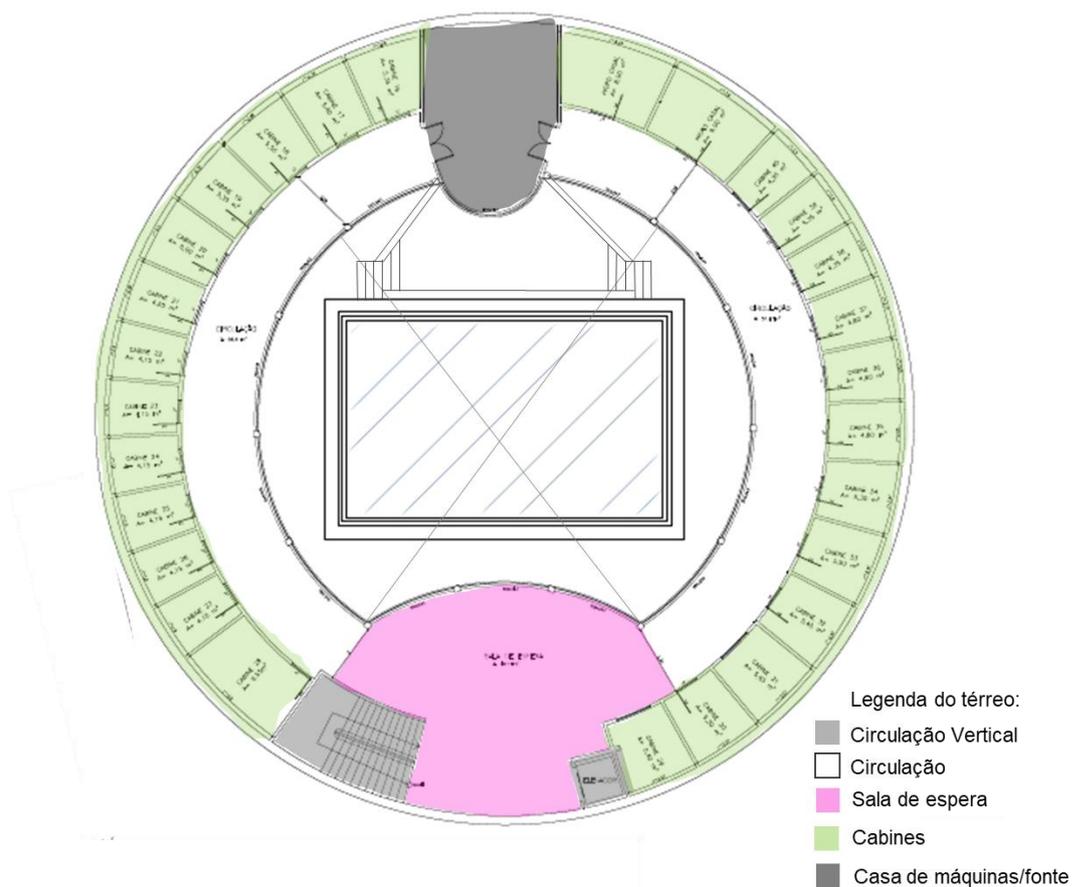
Esquema da planta baixa do pavimento térreo do Balneário Osvaldo Cruz. Adaptado de (ARQUIVO DA PREFEITURA DE IRAÍ, 2021).
